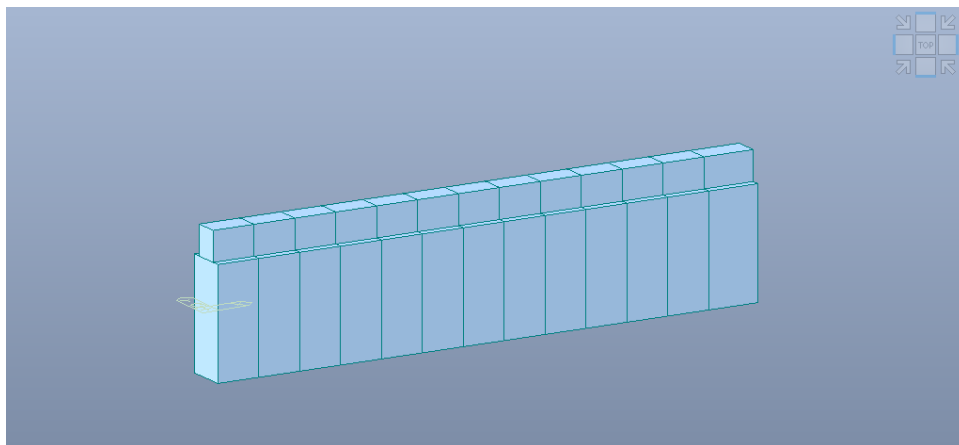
Schema con applicazione dei carichi – trave tipo 1
